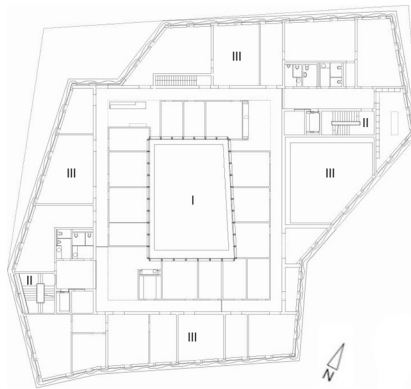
Grundriss 1. Obergeschoss M 1:1000
